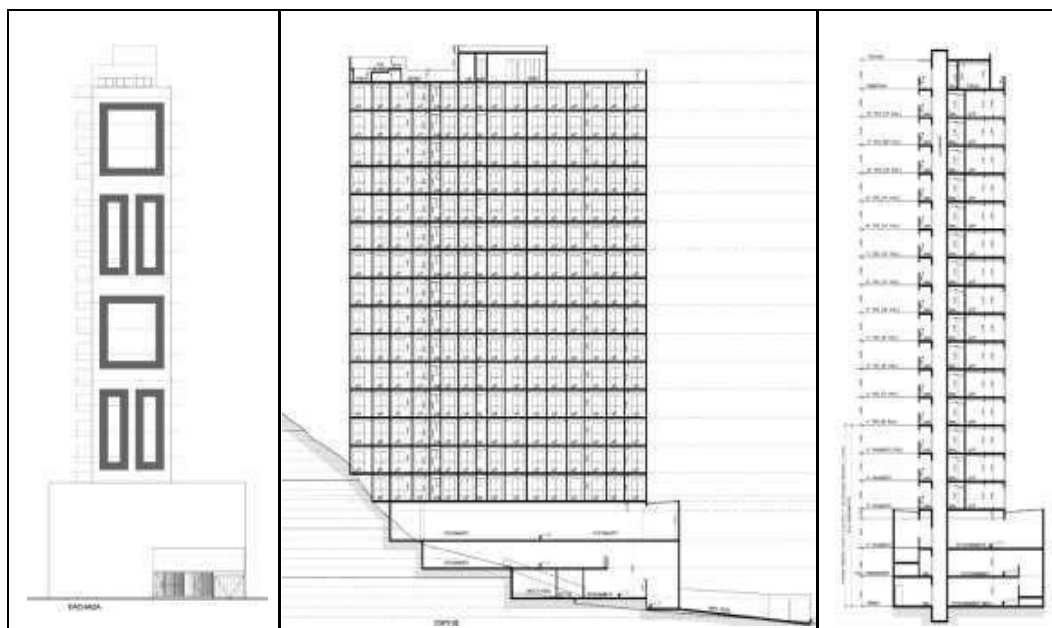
Fachada e cortes - Fonte: Projeto Legal
